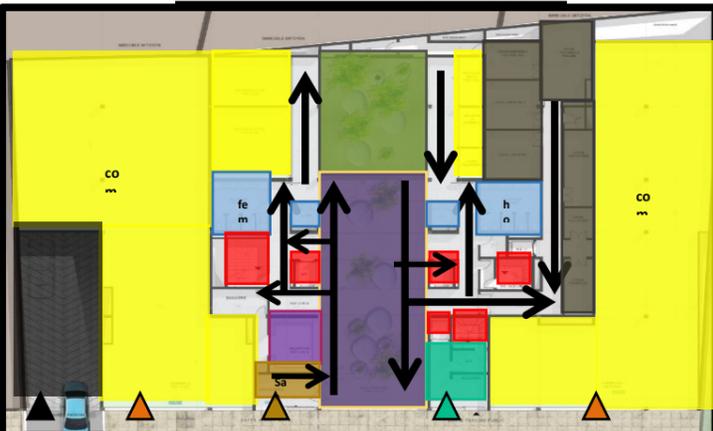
Plan de Rez de chaussée/source : <http://www.amush.org/apparthotel-casablanca-y-bouhaya-y-nejmi/>
